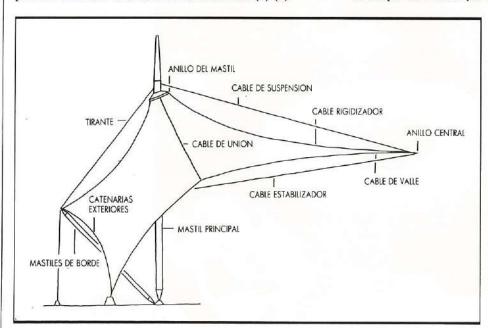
Unidad de la cubierta del Estadio de Riyadh. Elemento estructural.
